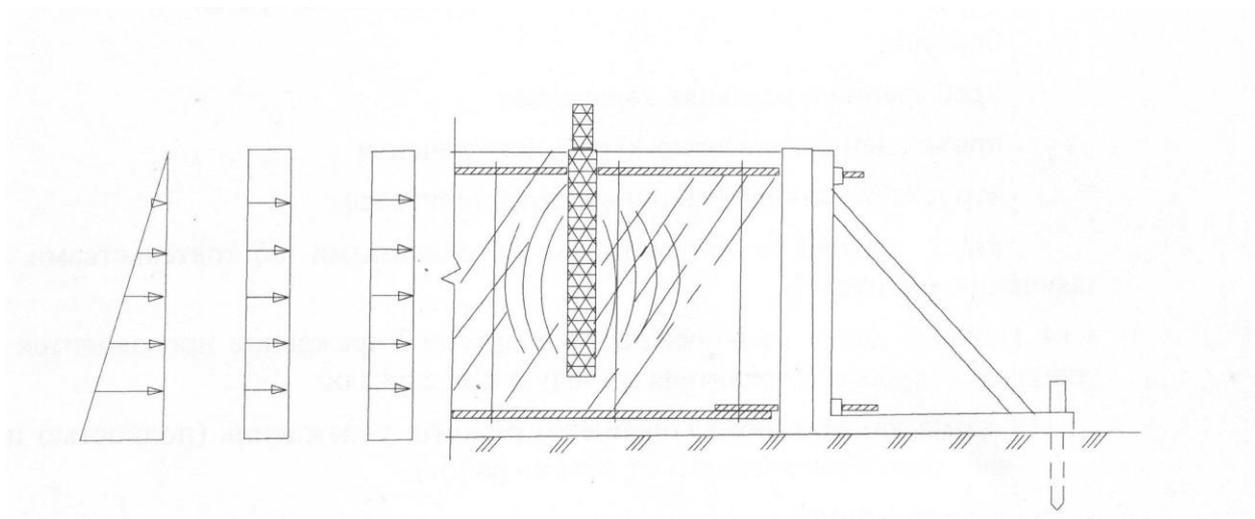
Расчетно-конструктивная схема опалубки фундаментной плиты
